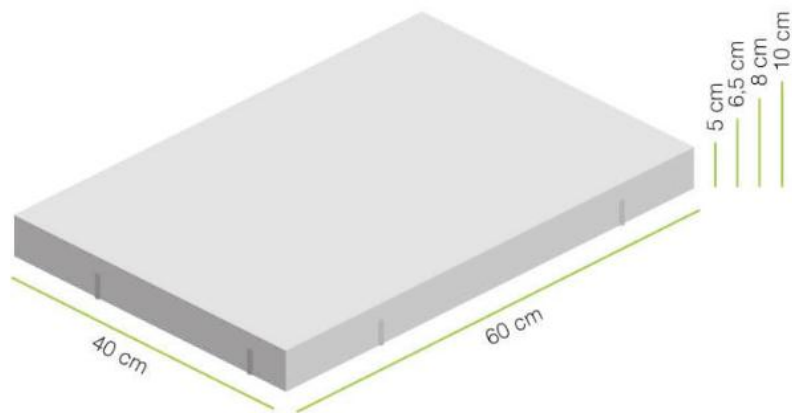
Solería de hormigón antideslizante para peatones en espacio público. Fuente: (Assael, 2008)
